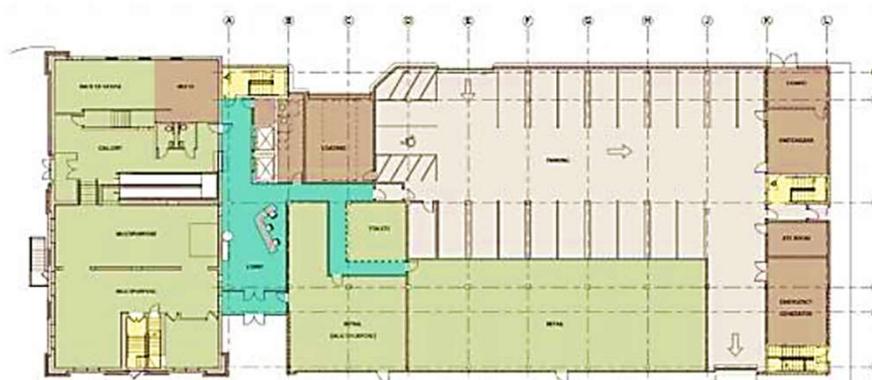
Planta Pavimento Térreo | Autor: Gensler
